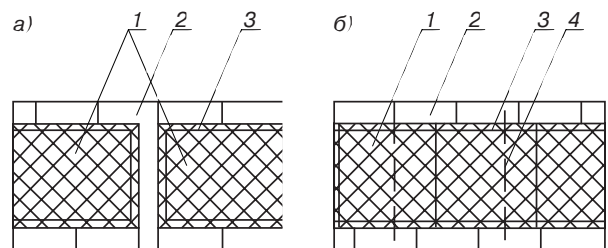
Конструктивные решения стеновых ограждающих конструкций из монолитного пенобетона: 1 – монолитный поробетон; 2 – керамический облицовочный или силикатный кирпич; 3 – арматурный каркас; 4 – стеклопластиковая связь
